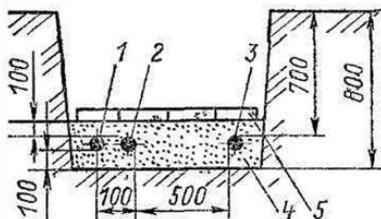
Прокладка кабелей 1—10 кВ с кабелями связи и с силовыми кабелями до 10 кВ, эксплуатируемыми другими организациями:
